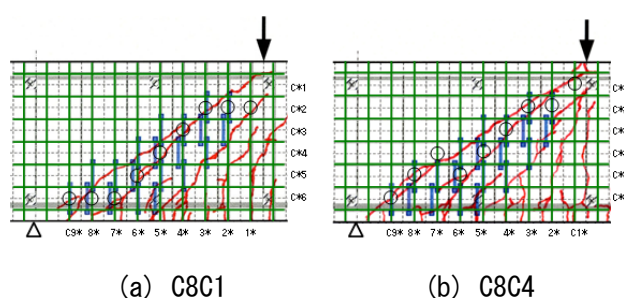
ひび割れ発生状 (荷重 1,300 kN 時) 状況
